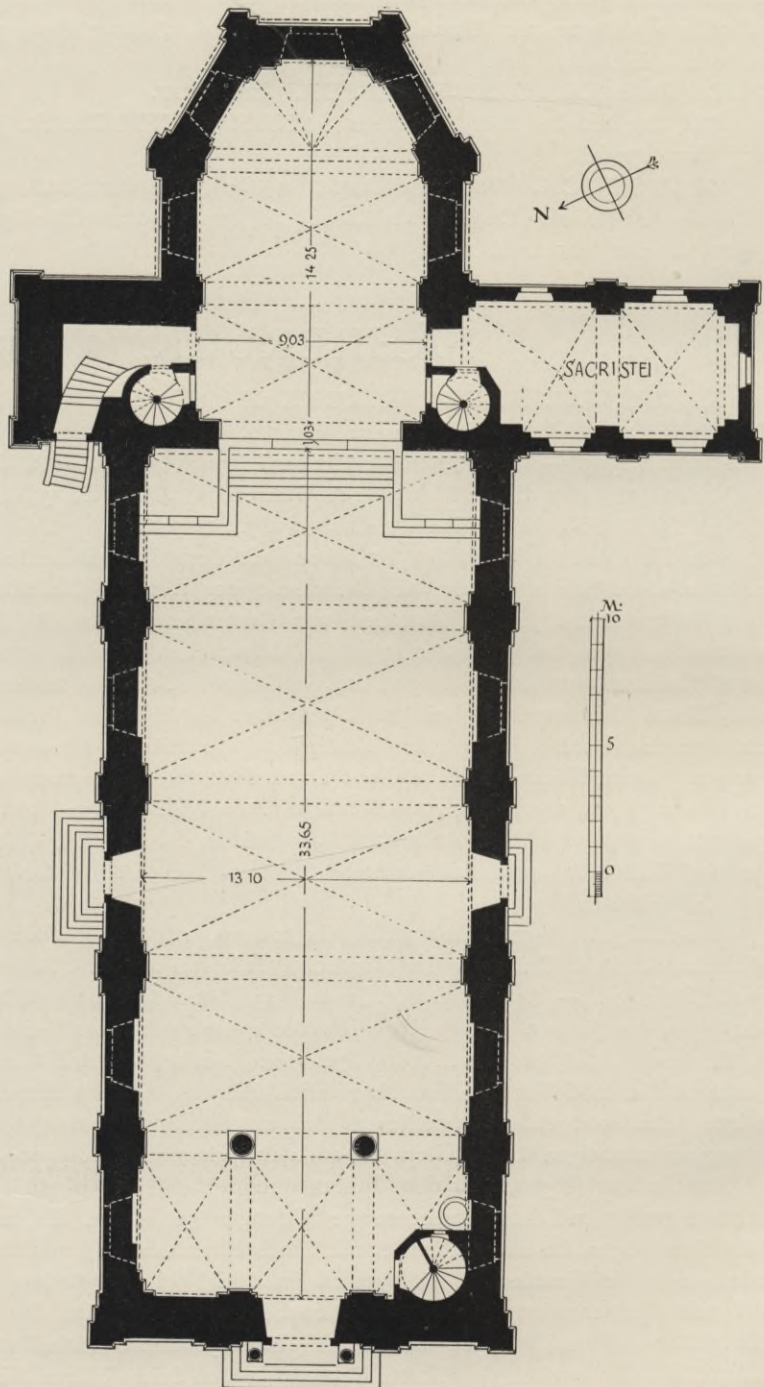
Fahrbrück. Grundriß der Wallfahrtskirche
